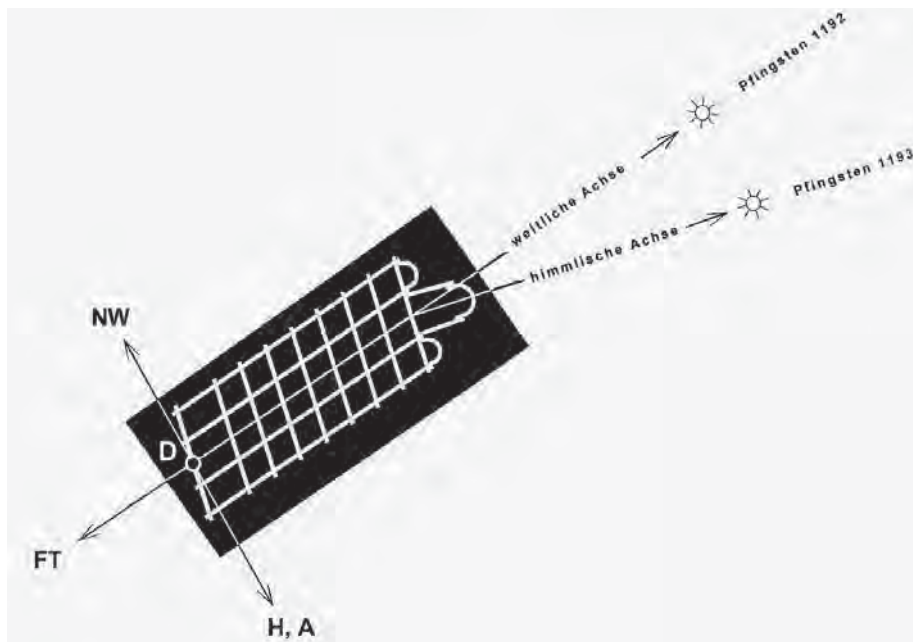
Absteckung Dom. Die Achse Langhaus ist lagerichtig und der Grundriss des Domes (Achsknick) stark verzerrt dargestellt.
